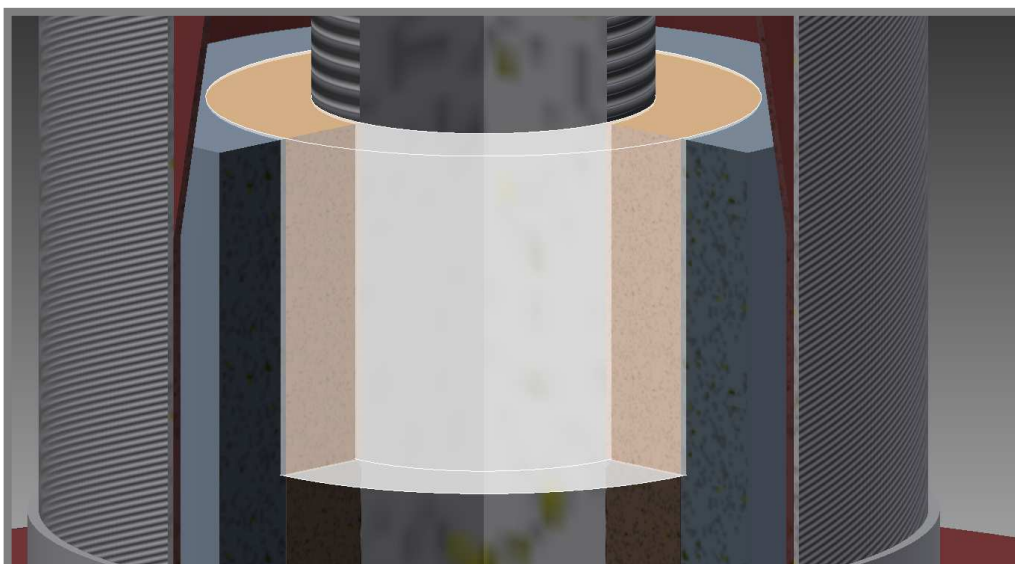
Detail konstrukčního řešení 1 (Guma plná a těsnící tmel)
